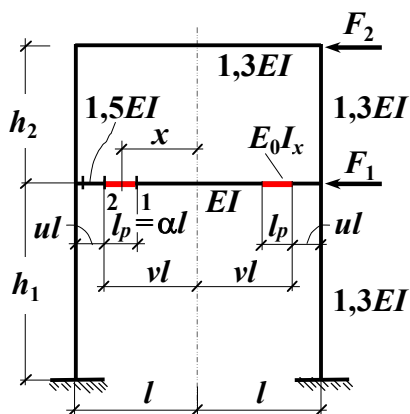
Расчетная схема 2-этажного каркаса с ПЗРС в ригеле 1-го этажа
